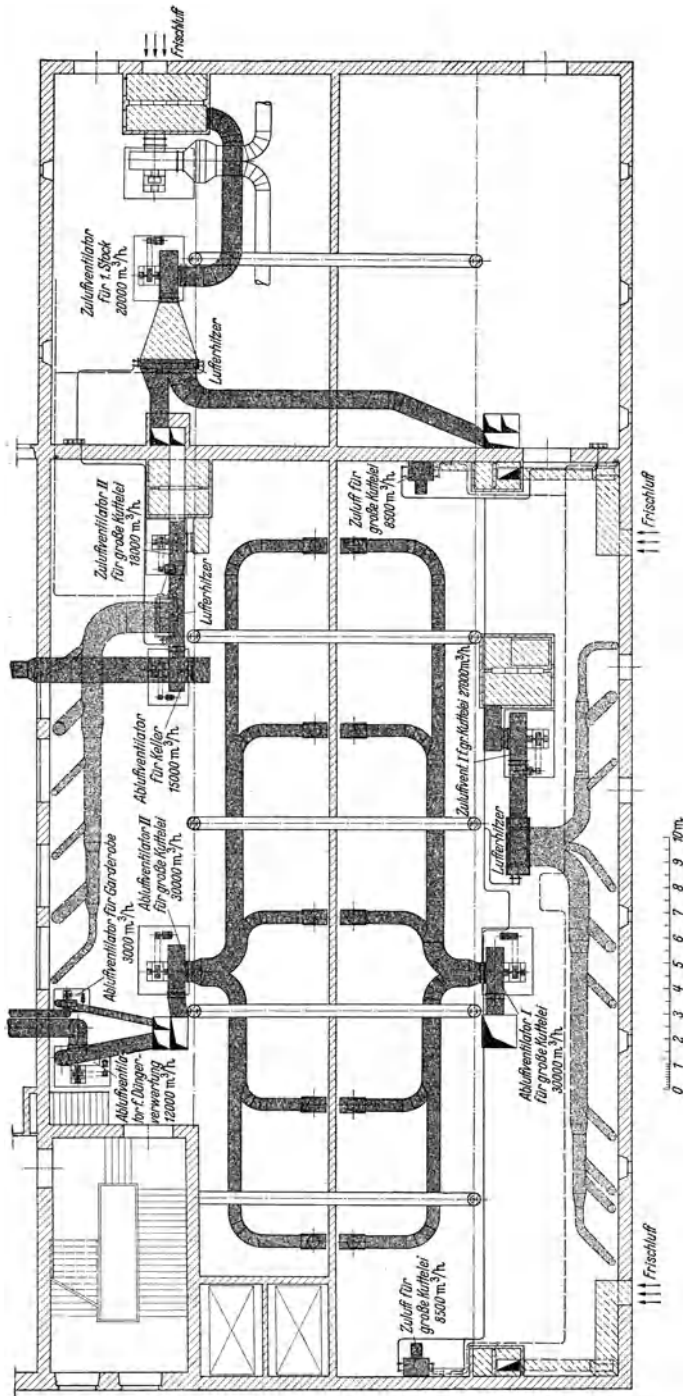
Ausgeführte Entnebelungsanlage für die große Kuttel einer Schlachthofanlage. Grundriß: Zwischengeschob für Lüfter und Luftkanalanlagen.
